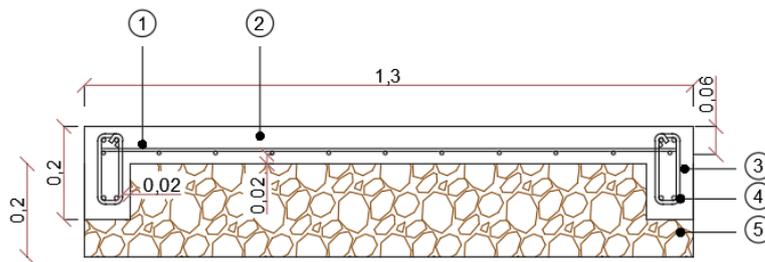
Anteproyecto vial: sección transversal bicisendas.
